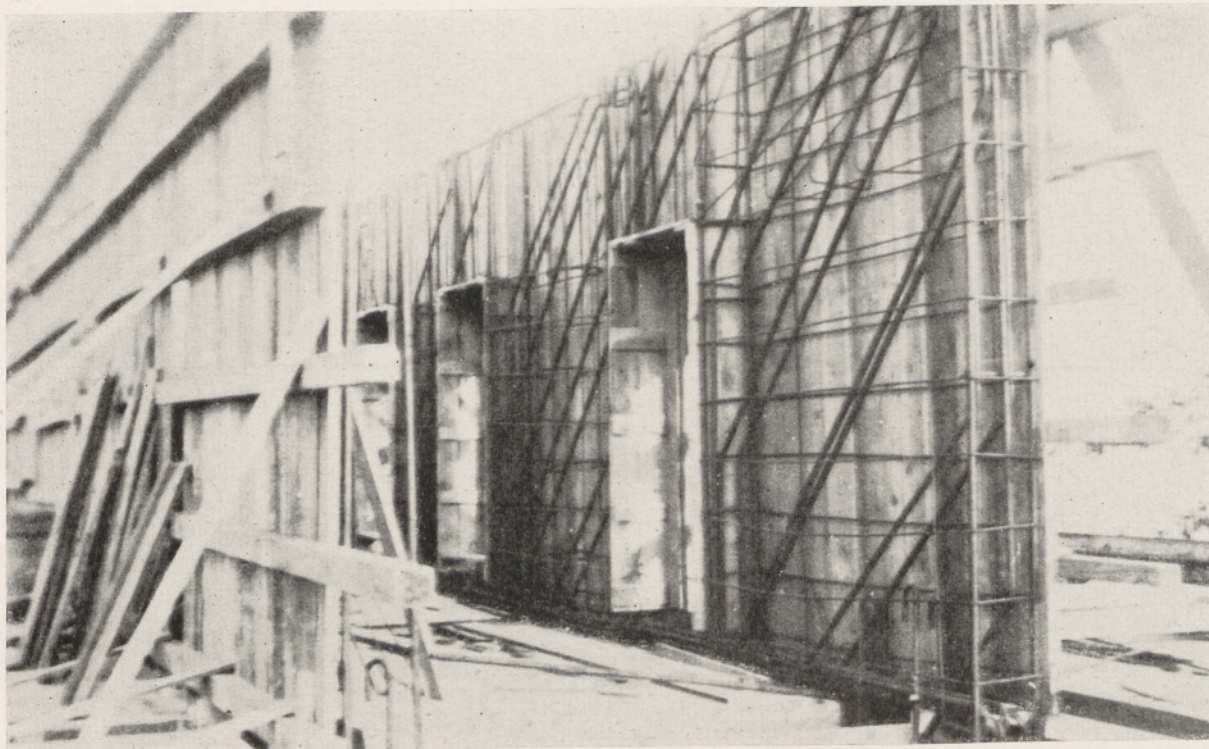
Eisenbetonkonstruktion am Kasinohotel in Zoppot im Bau
